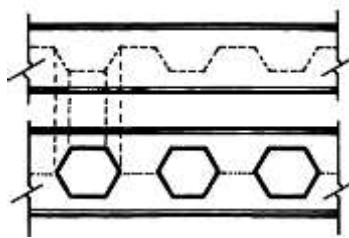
Vigas alveoladas armadas a partir de perfiles T
